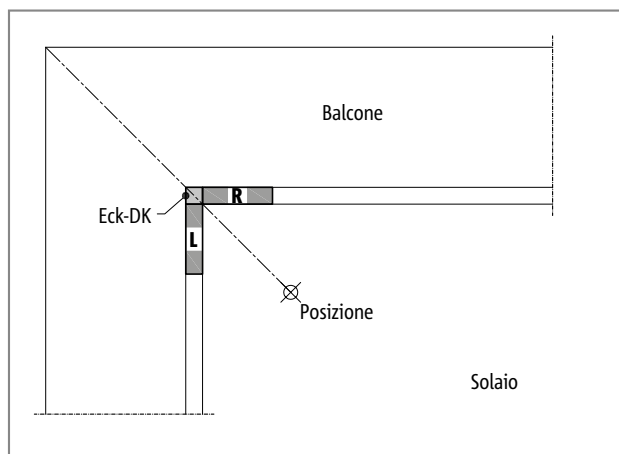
Schöck Isokorb® tipo EXT: disposizione EXT-L a sinistra della posizione; disposizione EXT-R a destra della posizione
